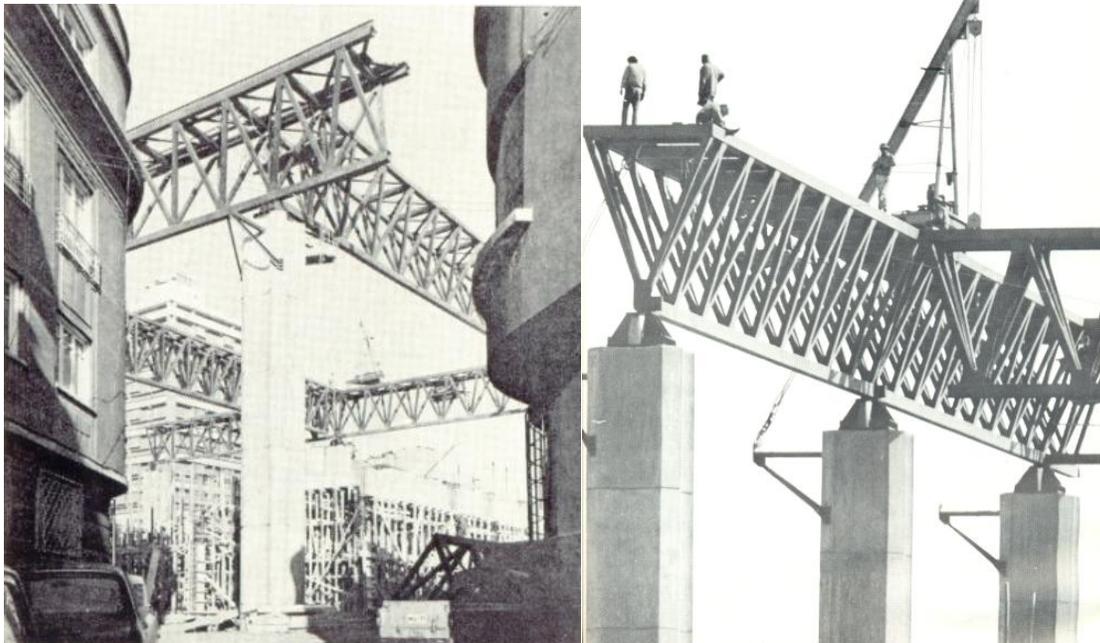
Ilustración XL – XLI: Vista desde la calle José Ramón Gutiérrez durante la construcción del conjunto UNCTAD III (AUCA Nº22, p.63). Imagen VI: Proceso de montaje de la placa con las columnas. Los *capiteles triangulares* son las piezas que unen placa y columnas. Se puede apreciar también el detalle del capitel que une el pilar con la viga.
